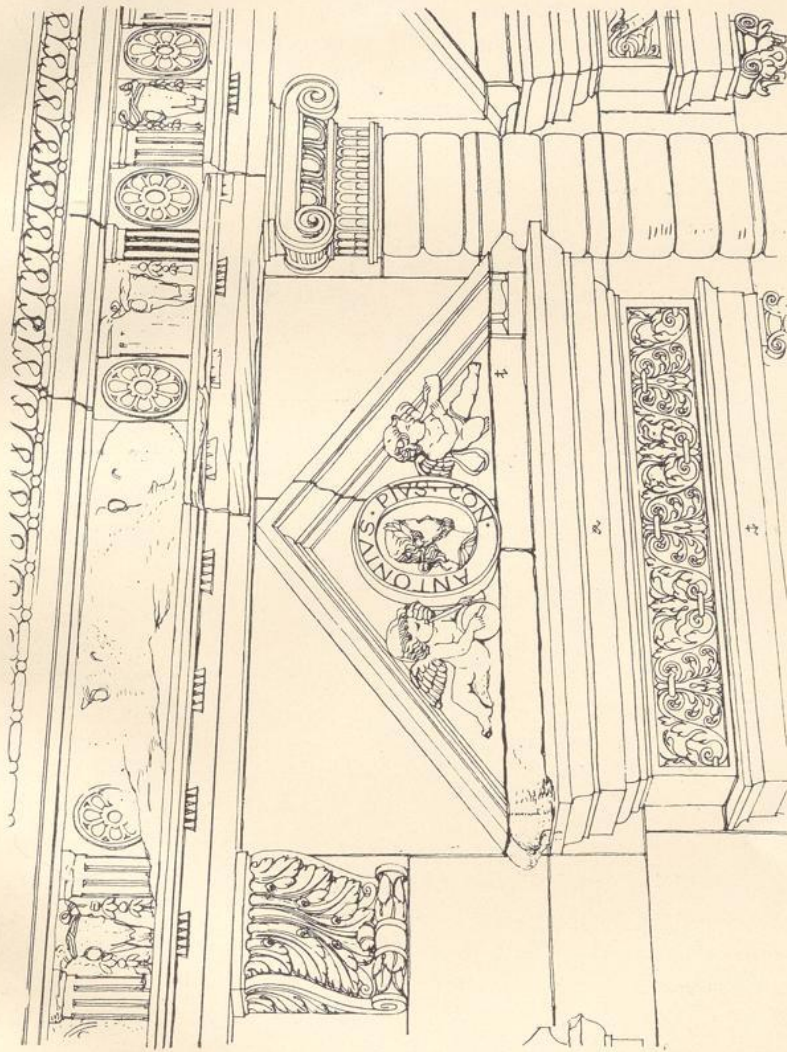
Fensterverdachung im Erdgeschoss des Otto Heinrichsbau.
